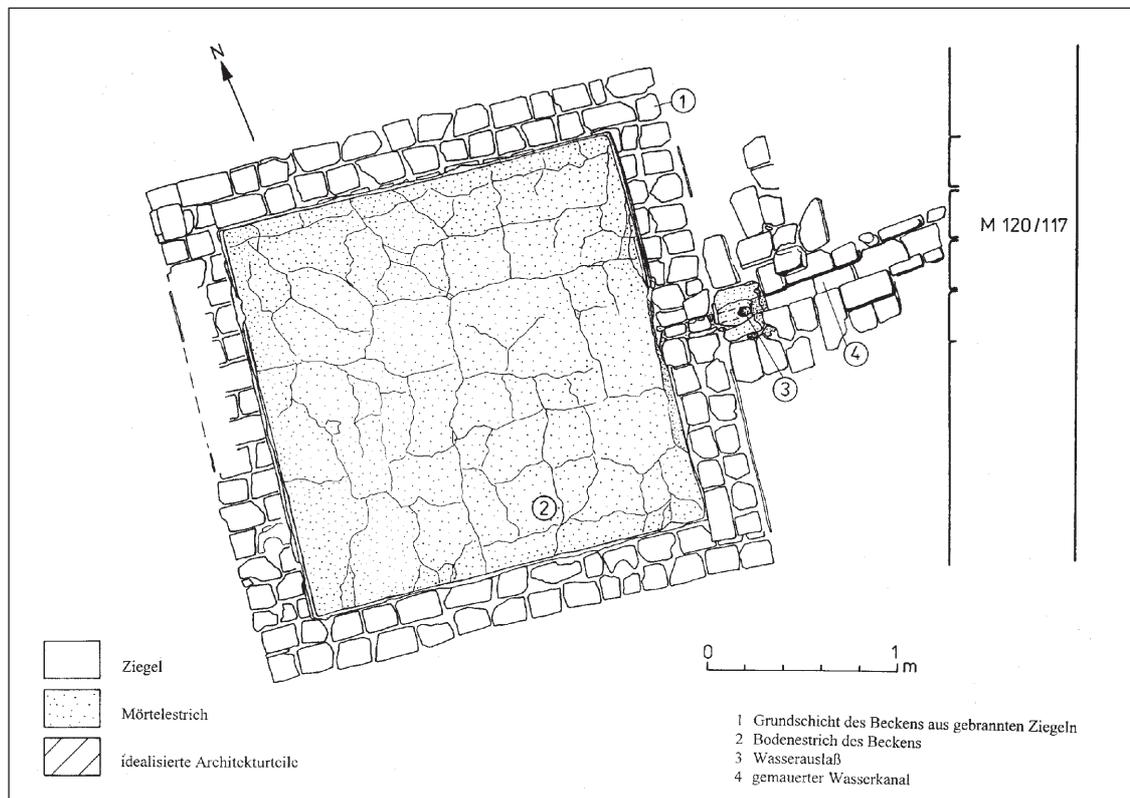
Wasserbecken K 420 im Schnitt 120.18-19, Grundriß (Plan P-IA/0318)
